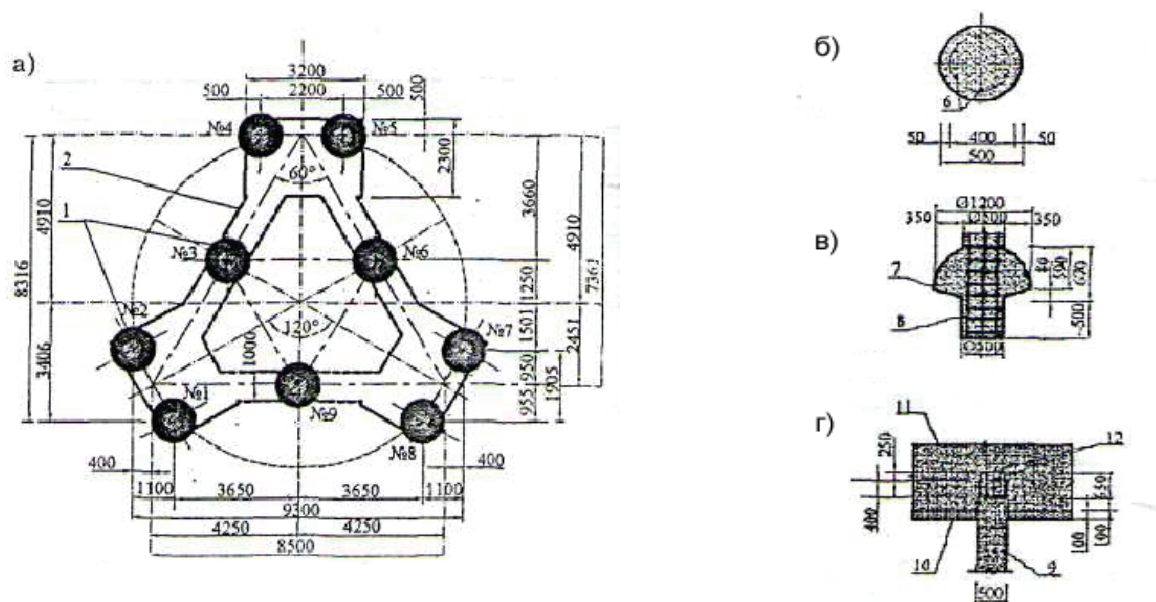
а — план пального поля фундаменту башти із буронабивних палі марки БП 180.50/120; б — залізобетонний перетин палі; в — деталь нижнього кінця палі; г — деталь з'єднання палі з ростверком
